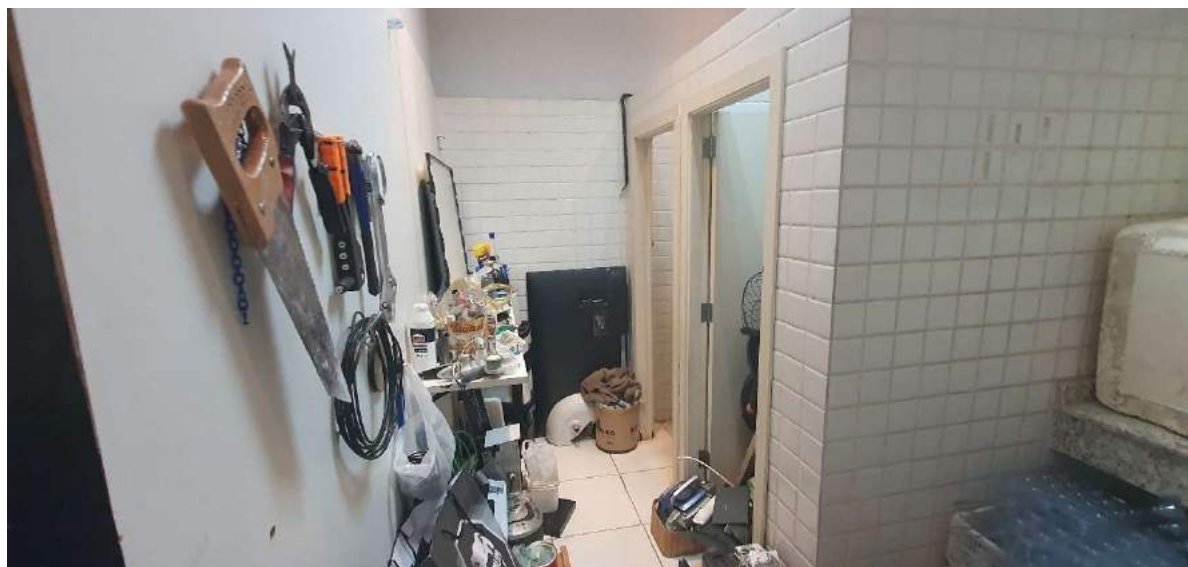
VISTA DO BANHEIRO DIREITO, ADAPTADO PARA OUTRO USO.
